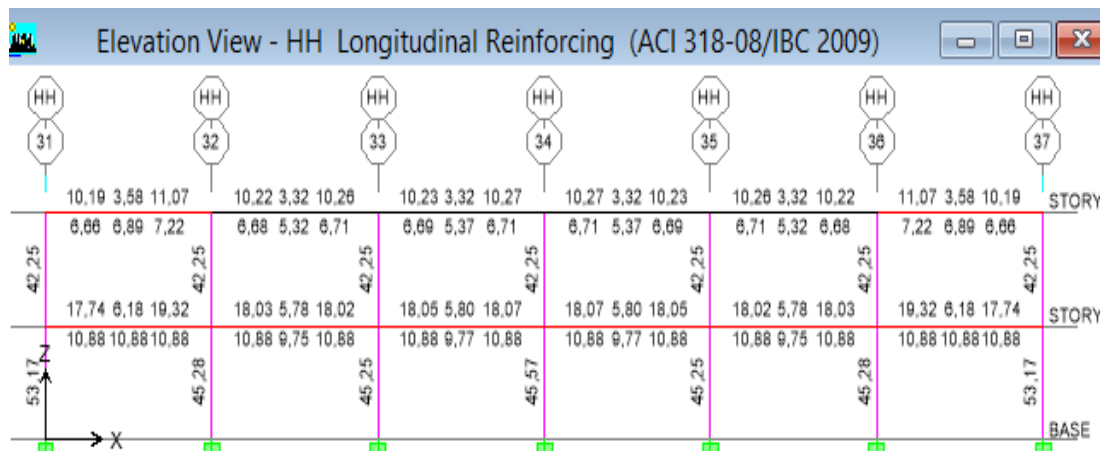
Acero en Vigas y Columnas en el Pórtico HH – C. Quirúrgico- (NEC-11)
